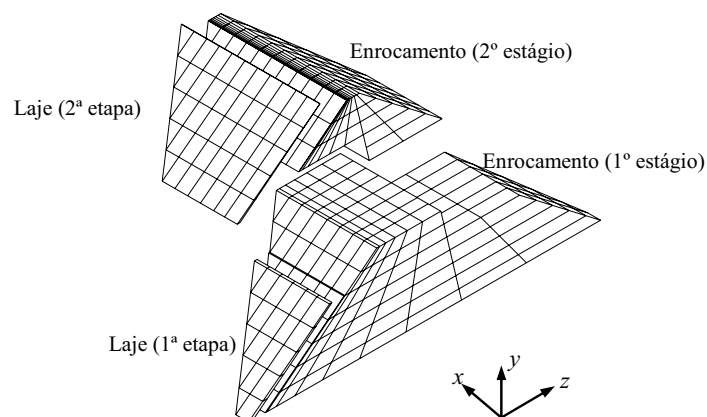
Exemplo do Processo Construtivo da barragem e da face de concreto.
